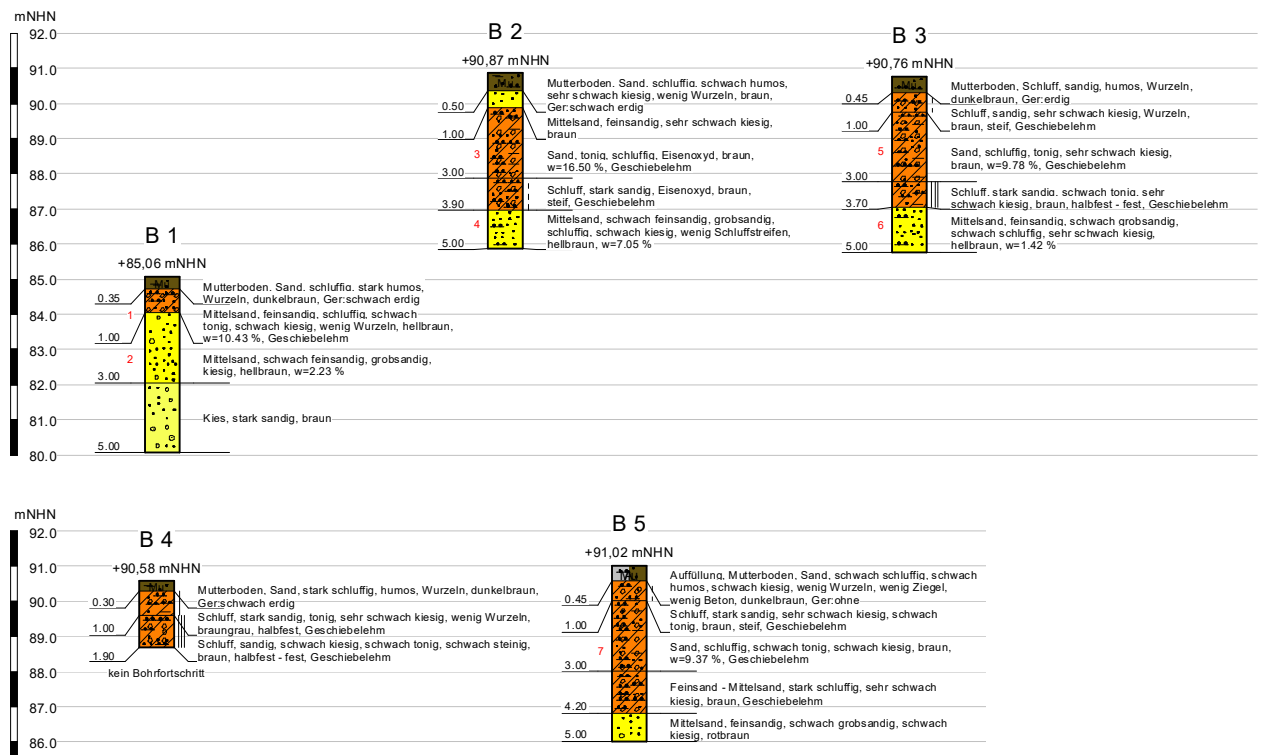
Bohrprofile und Lageplan der Erkundungsstandorte
